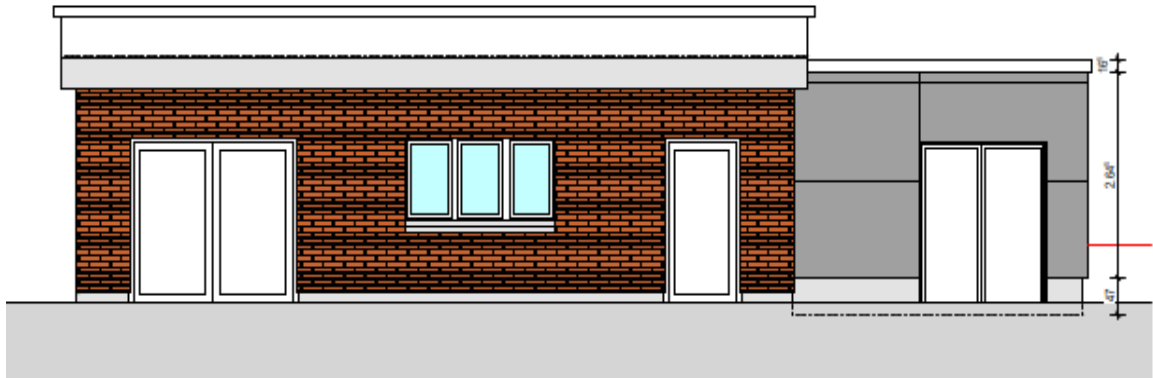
Ostfassade Rechengebäude mit Anbau Pumpwerk
